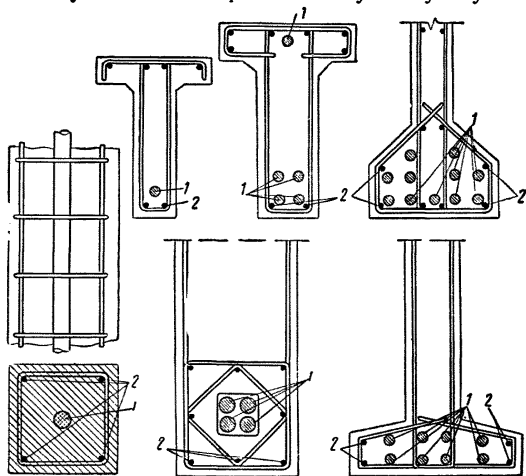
Схемы расположения ненапрягаемой и напрягаемой арматуры
